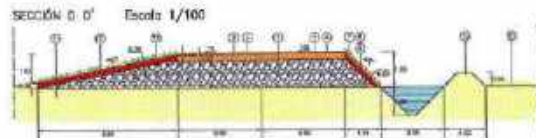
SECCION TRANSVERSAL DEL DIQUE DEL CAMINO DE GUARDA EN LOCALIZACIONES DONDE HAY ACEQUIAS Y DRENAJES PREEXISTENTES.
